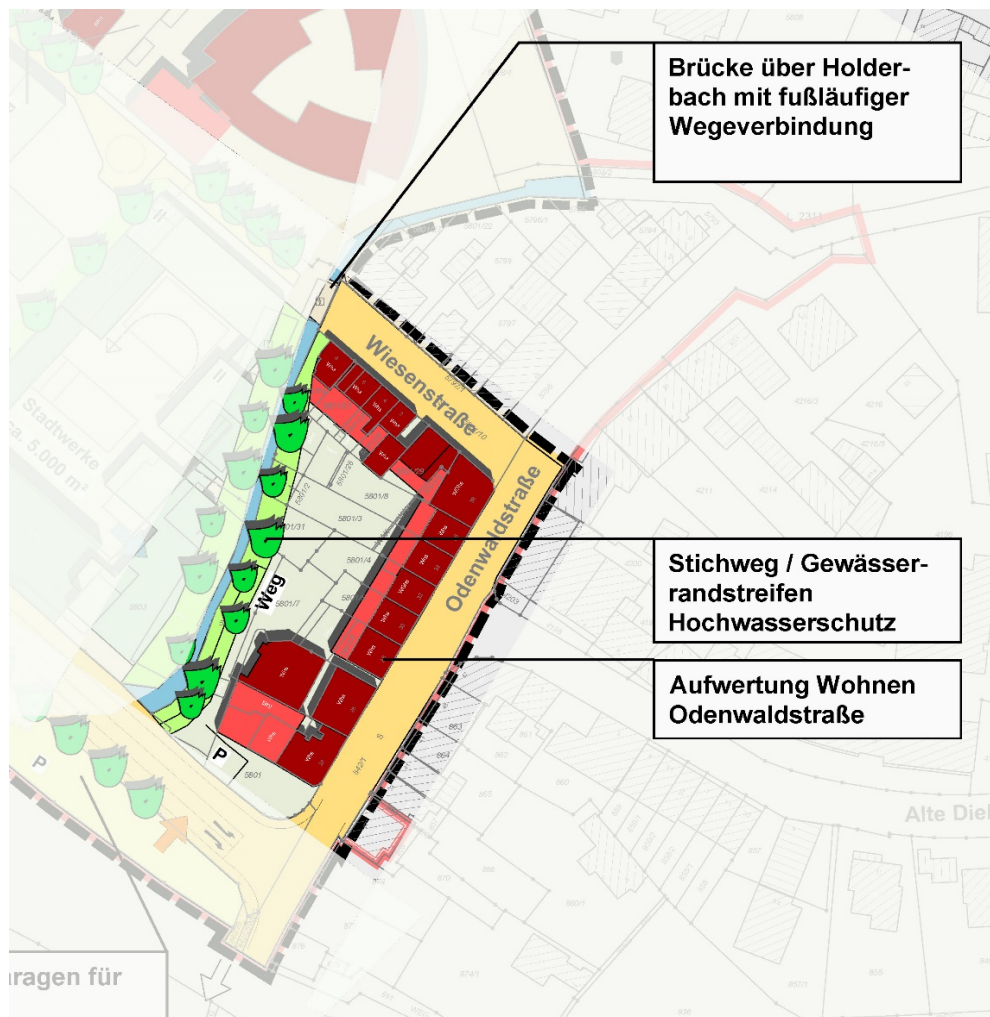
Teilbereich Wiesenstraße-Odenwaldstraße
